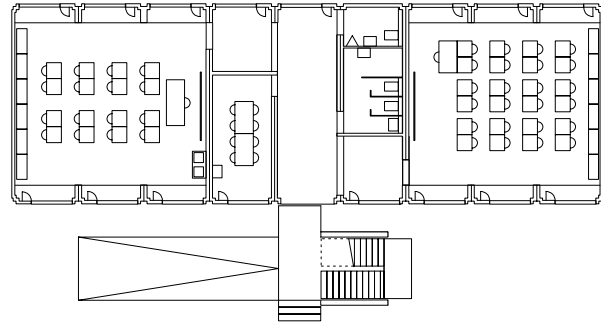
Züri-Modular, Bild und Grundriss / Bauart Architekten und Planer AG
